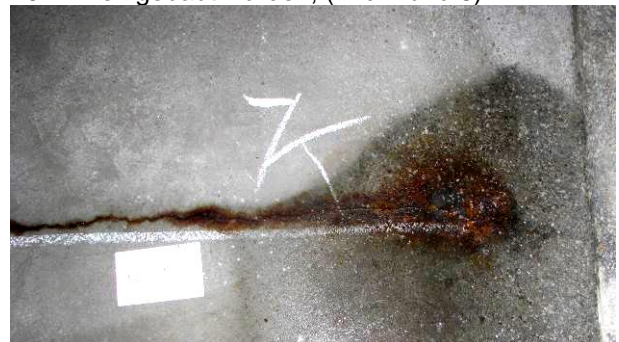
Riss mit Rostfahnen über eingebettete Höhenleere (Sollrissstelle)
